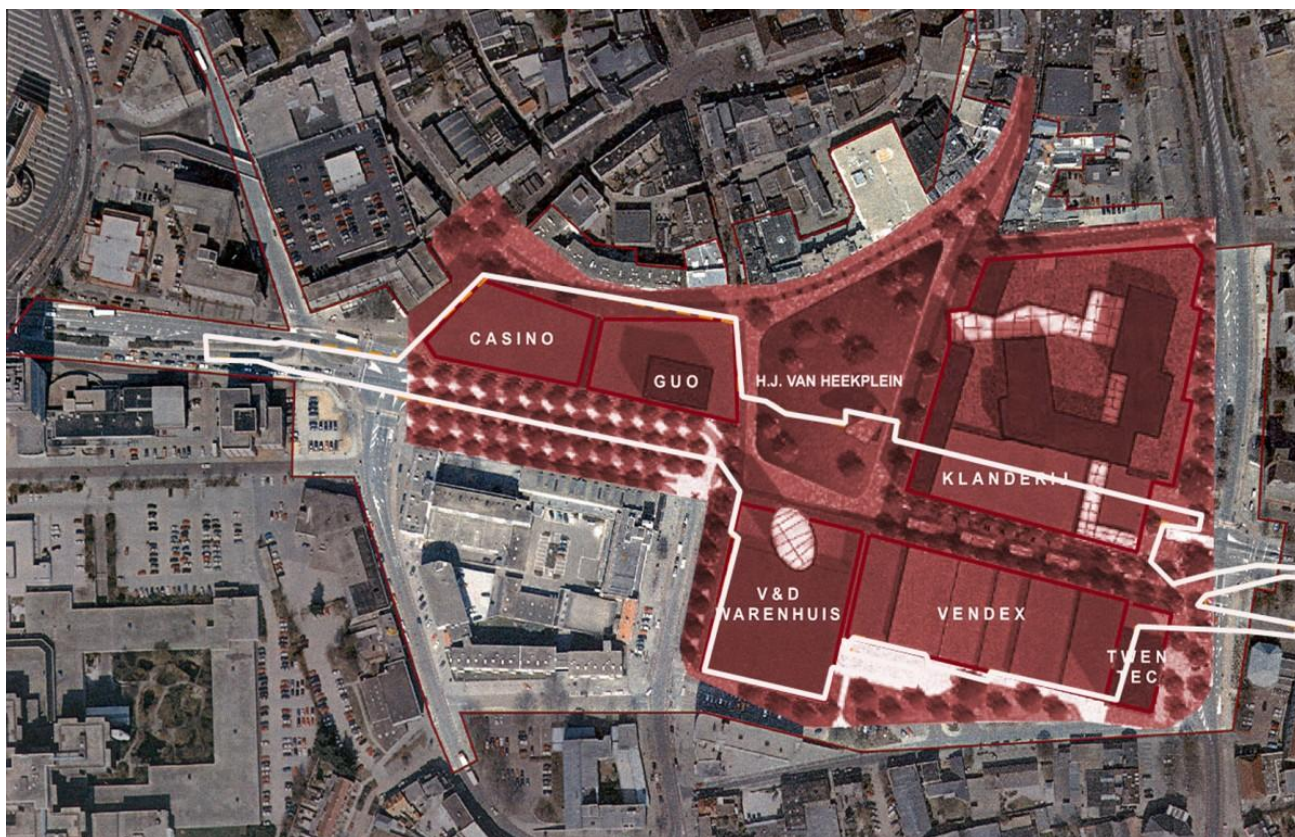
Overzicht van de parkeergarage. Met rood is het winkelgebied van het Van Heekplein aangegeven. De witte belijning geeft de ondergrondse parkeergarage aan.
